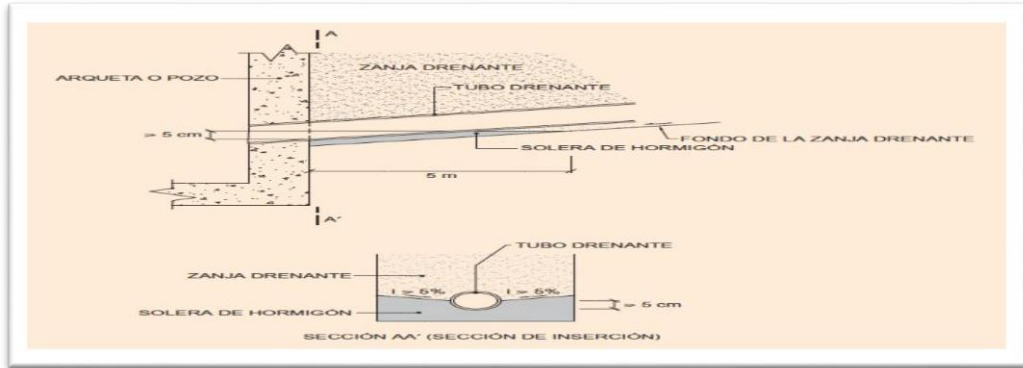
Carreteros.org. (2009). Recomendaciones para el proyecto y construcción del drenaje subterráneo en obras de carretera. 2020, de Carreteros.org Sitio web:
